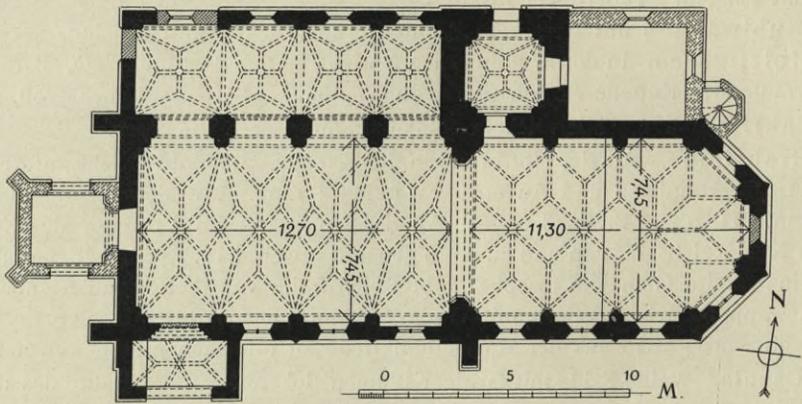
Hoheneggkofen. Pfarrkirche. Grundriß.
